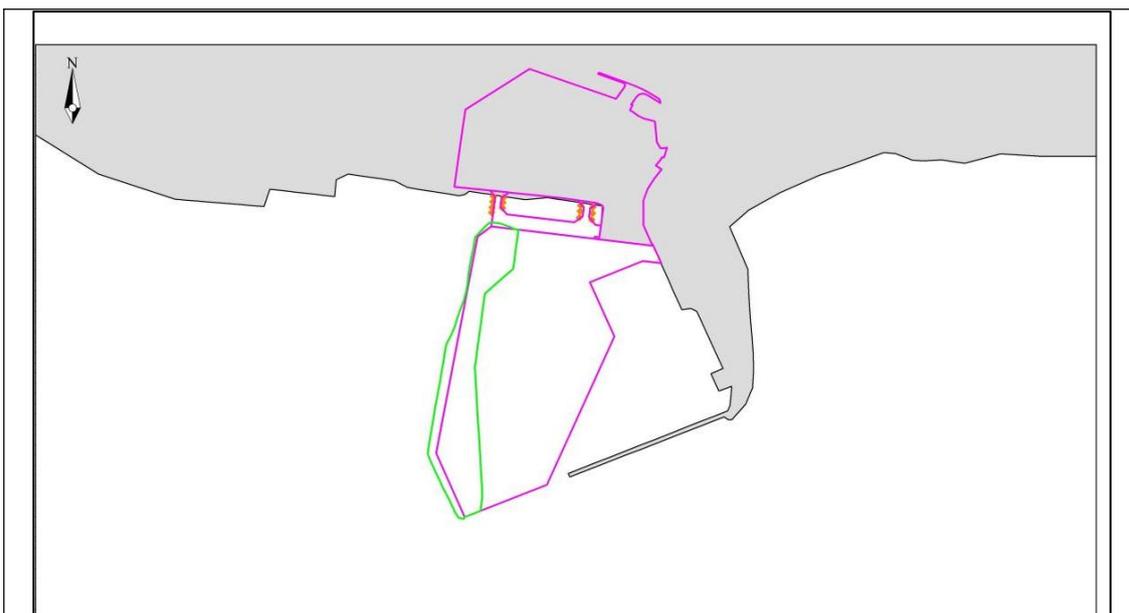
施工平台钢管桩插入及拔除施工悬沙源强点位图
